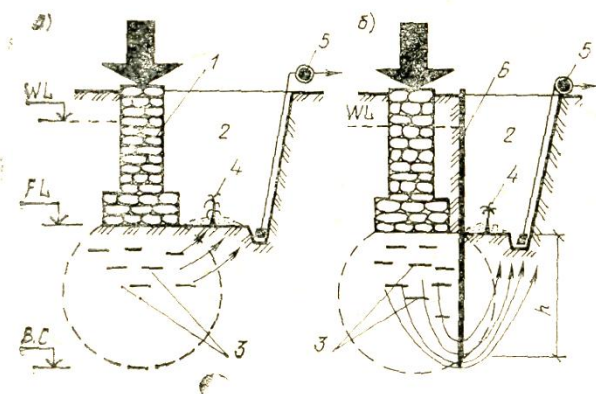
Суфозійне руйнування ґрунту під існуючими фундаментами при відкритому водовідливі: *a* – без огорожуючого шпунта; *б* – при шпунті, який не забитий до водоупора або недостатньо заглибленим нижче дна котловану; 1 – існуючий фундамент; 2 – котлован будинку, що споруджується; 3 – зони ймовірного утворення порожнин; 4 – грифони; 5 – насос; 6 – шпунт; *h* – глибина занурення шпунта нижче відмітки дна котловану
